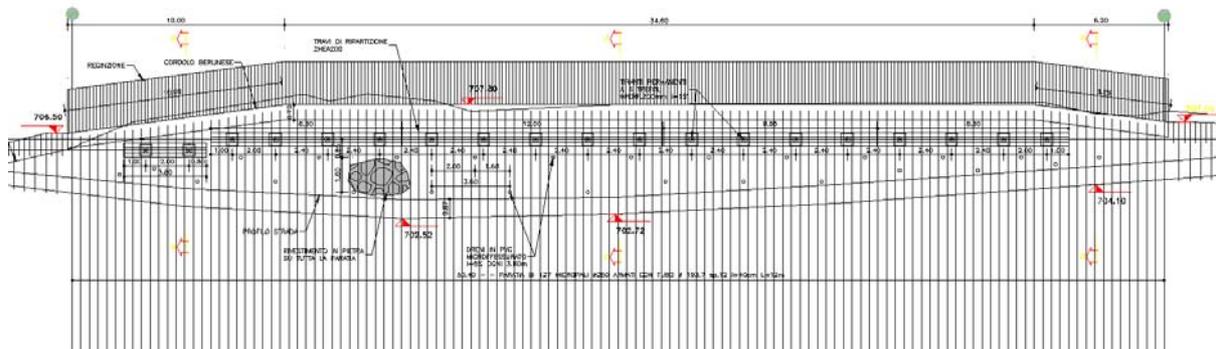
Prospetto berlinese di collegamento alla viabilità esistente
